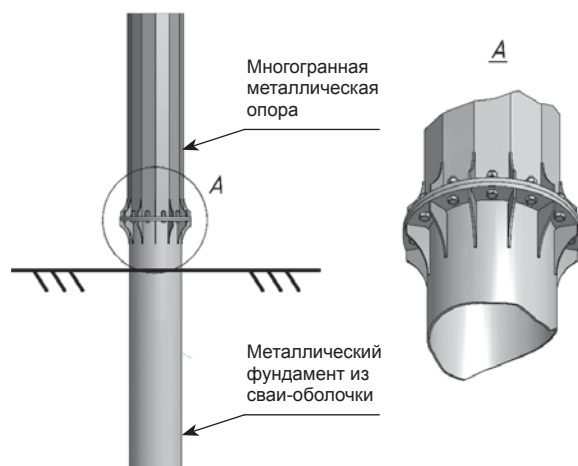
Схема фундамента из сваи-оболочки трубчатого сечения
